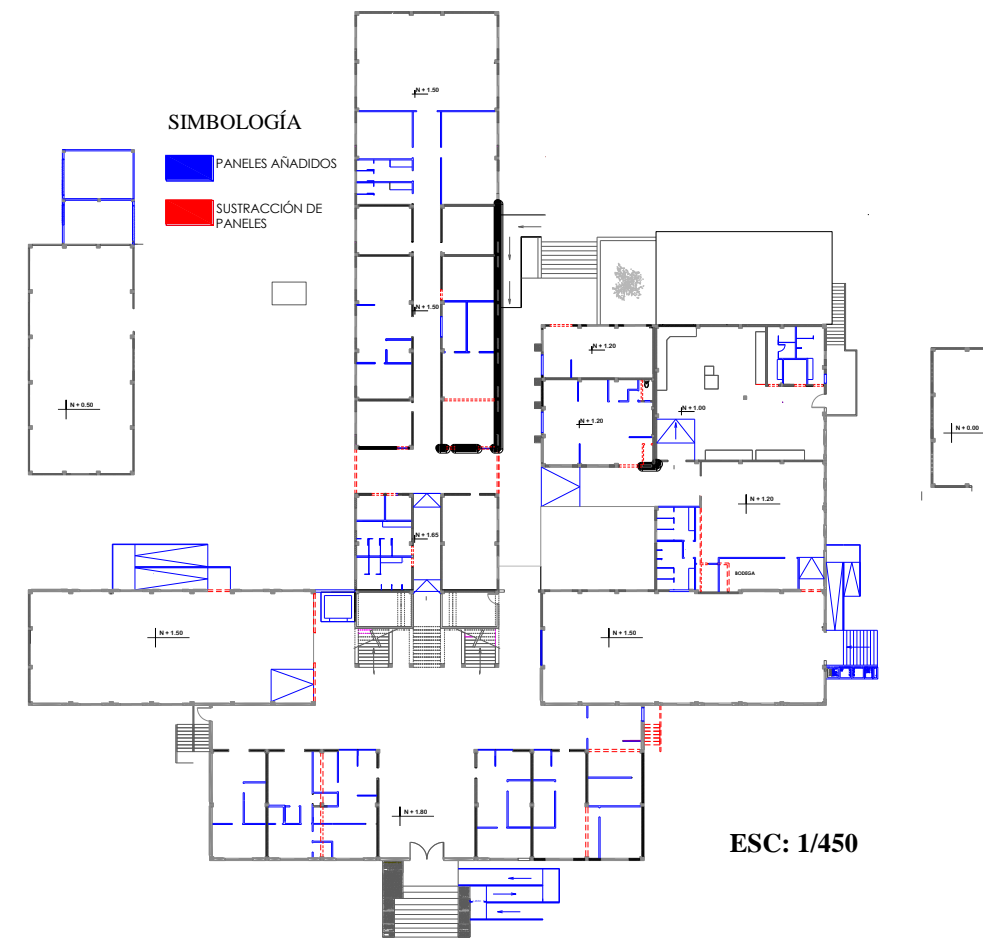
Planta Baja Academia Militar Juan Gómez Rendón. (Municipio).
